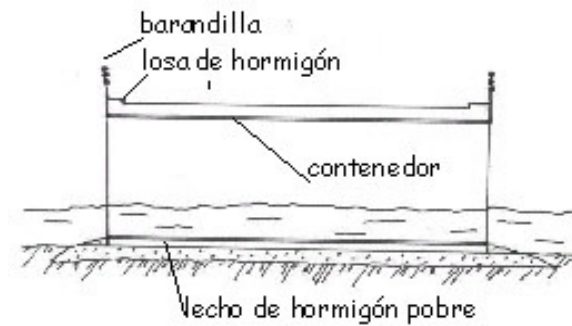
Sección transversal tipo. Ingrid Raventós (2000).
